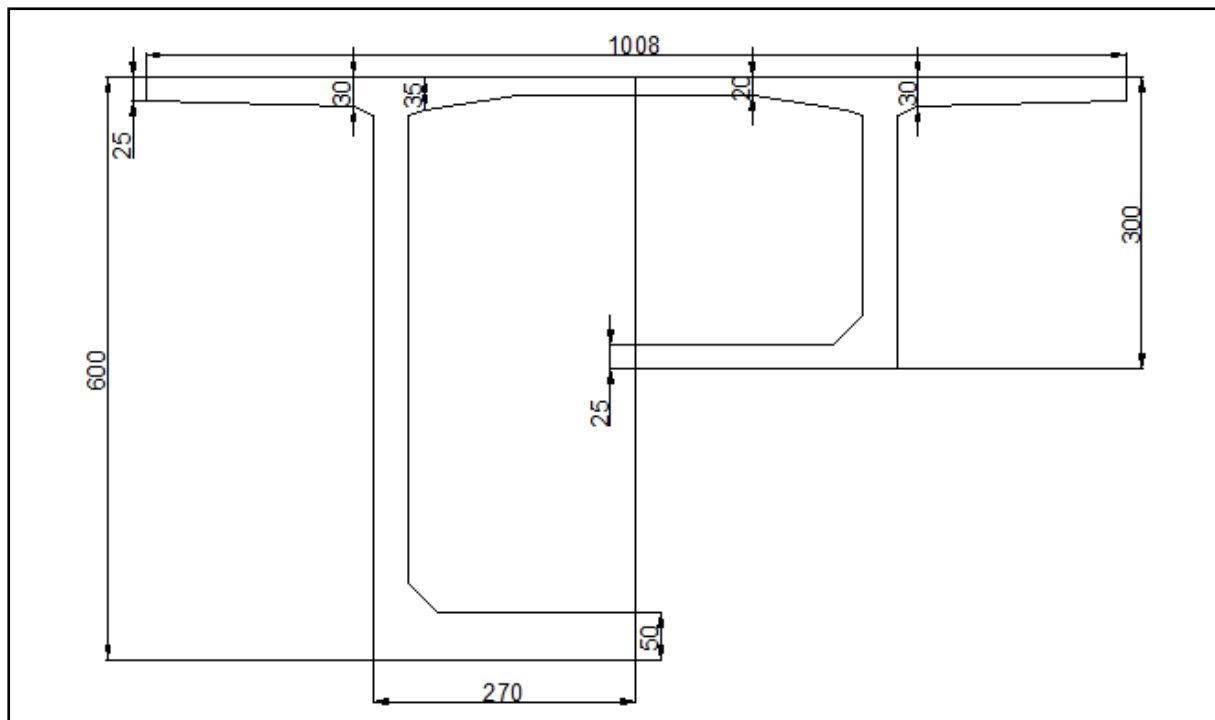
Coupe transversale de la section sur pile et à la clé.
